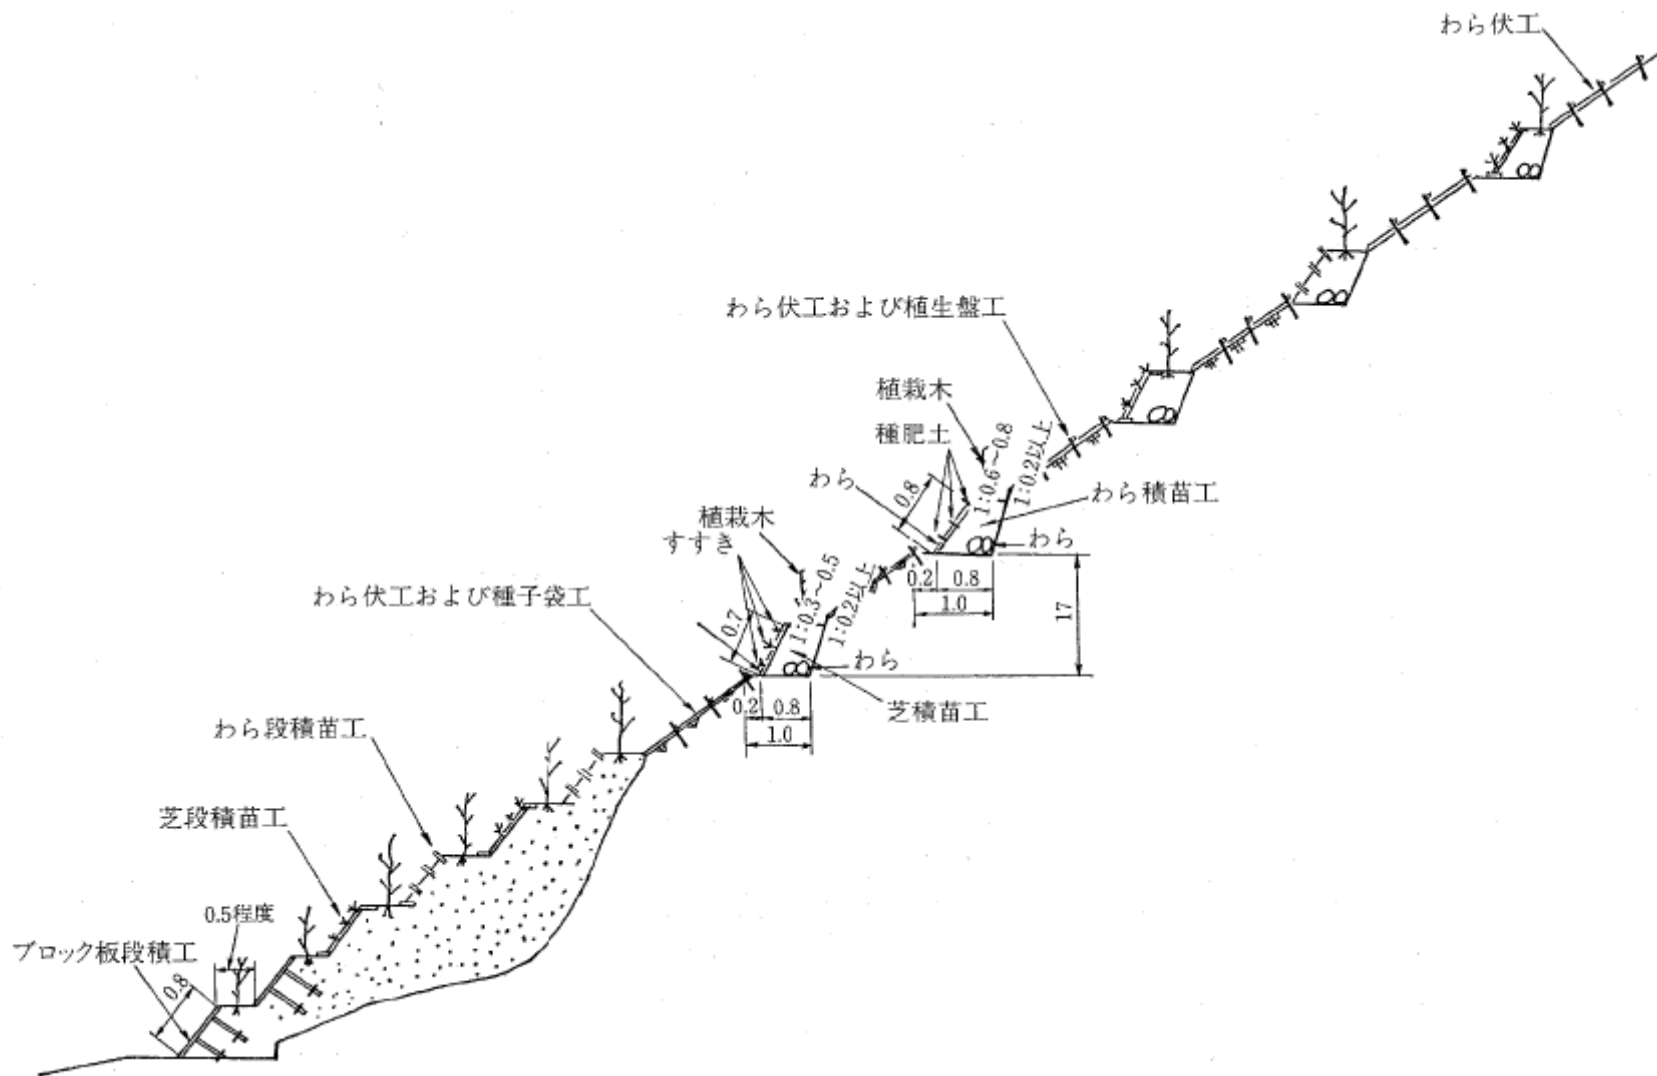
とくしゃ地 (施工例) 断面図 (単位 : m)
